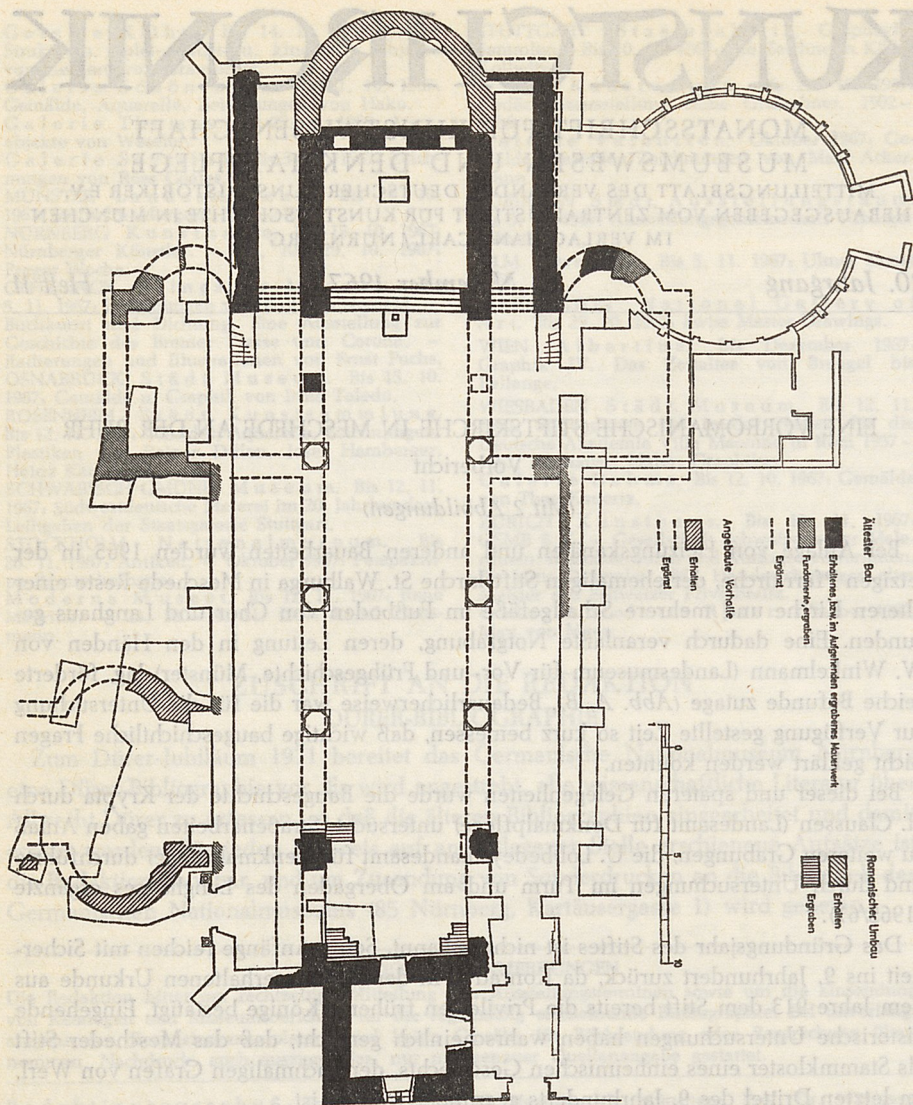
Abb. A Meschede, ehem. Stiftskirche St. Walburga. Grundriß.
